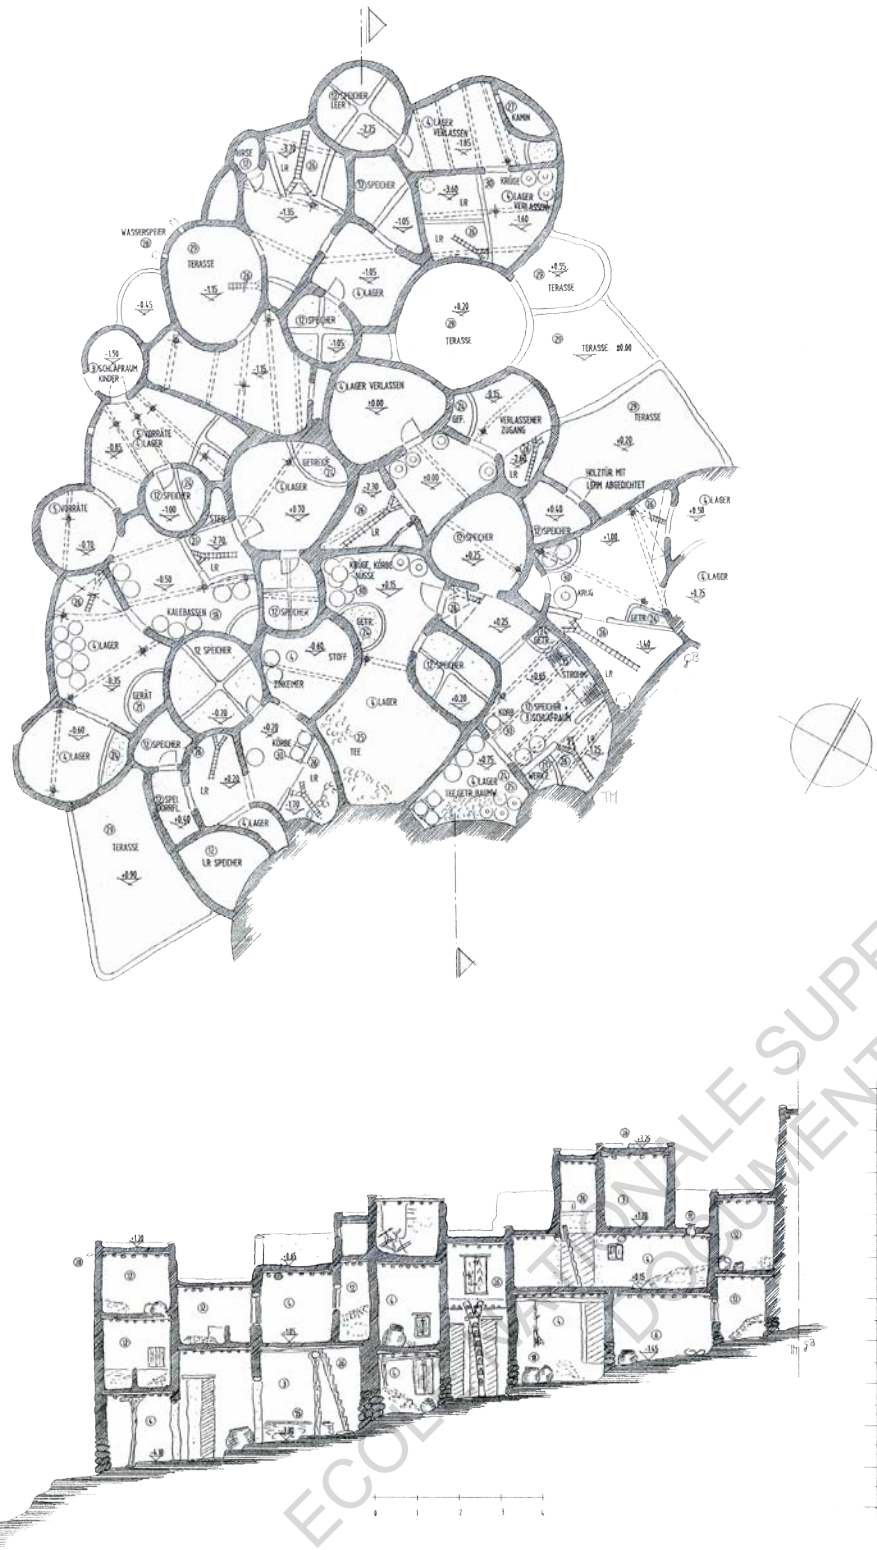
Plan et coupe habitation Dogon / Photographie : Tobias Müller & Gunter Braun
